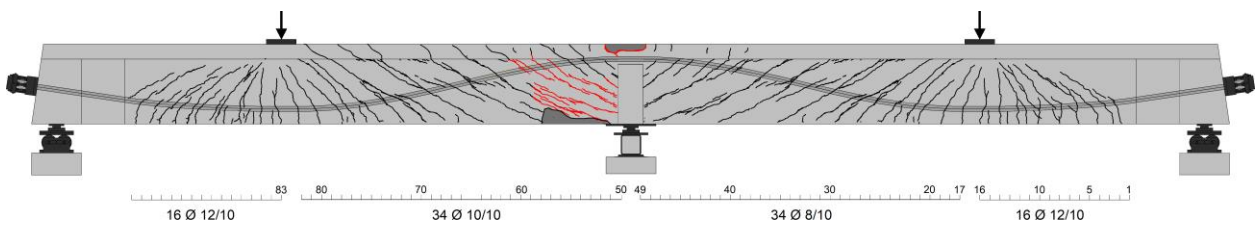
Rissbilder im Bruchzustand (Versagensrisse rot)
